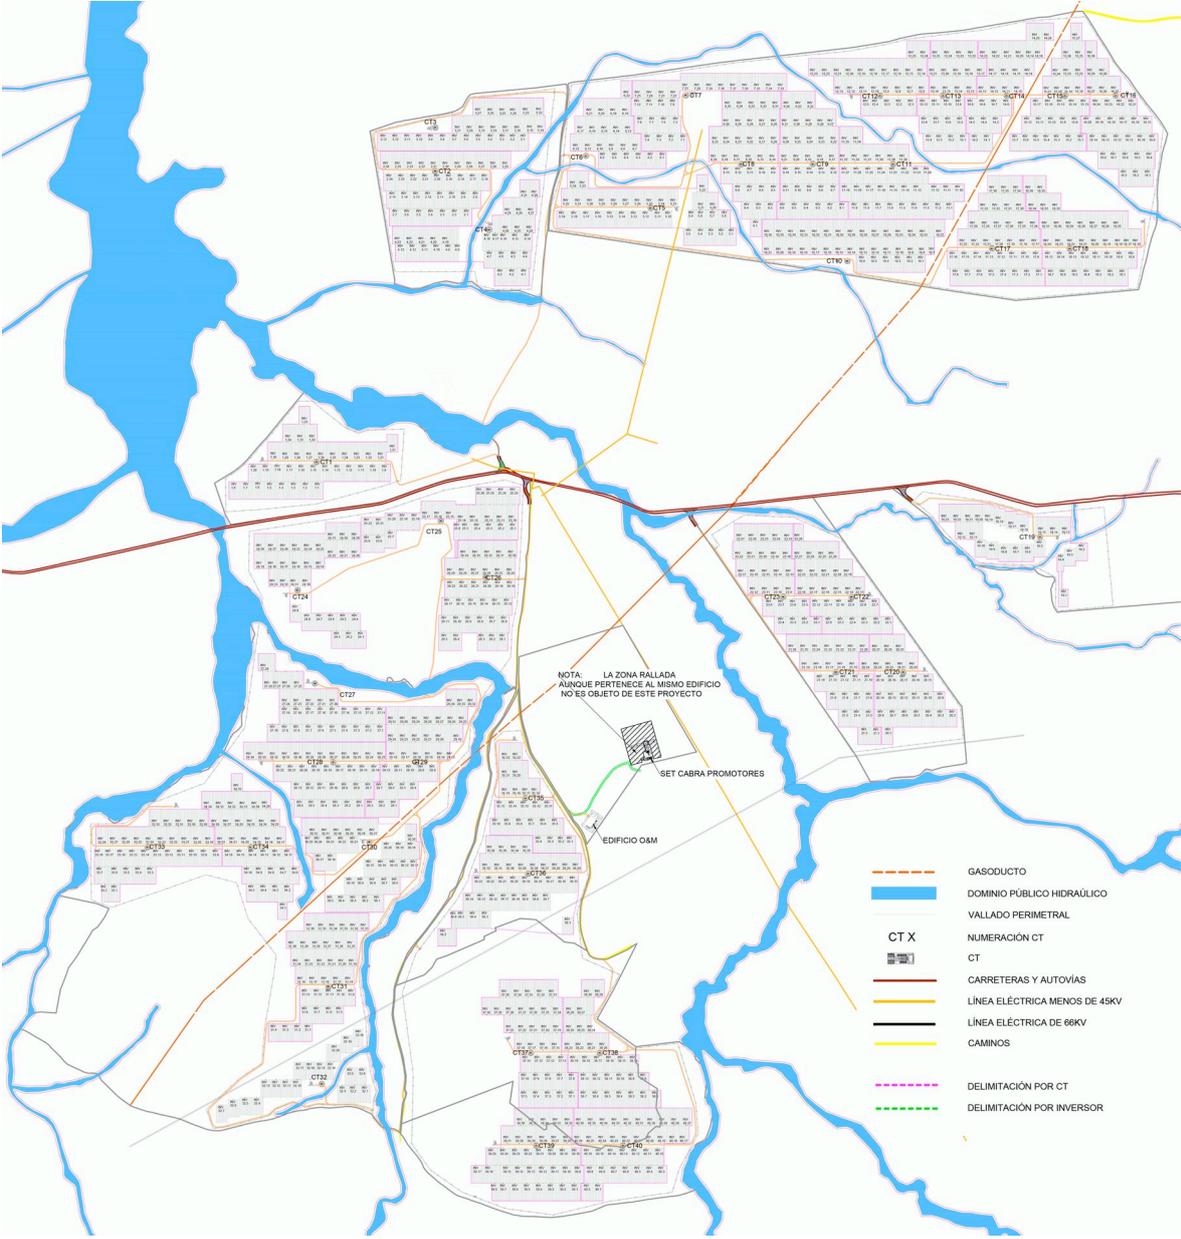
Layout General de la Planta Solar Fotovoltaica.
